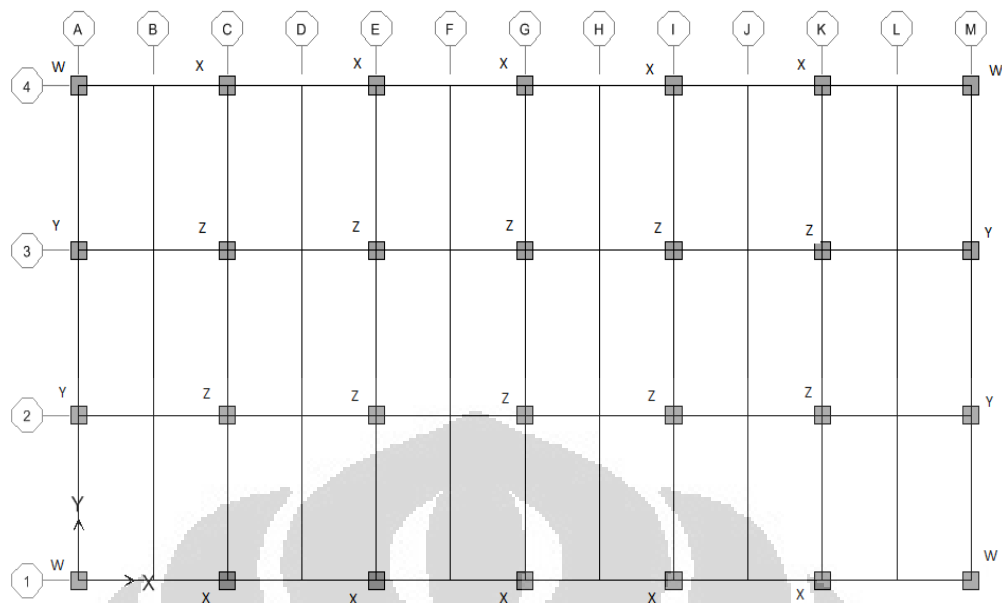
Denah Bangunan serta Pengelompokan Balok
